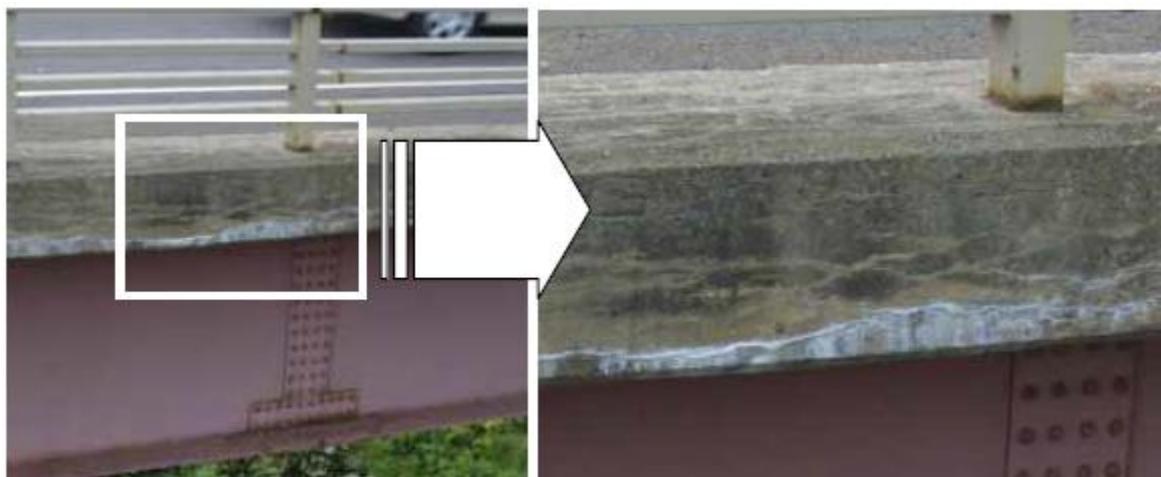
地覆の側面および天端に生じた長手方向のひび割れ
